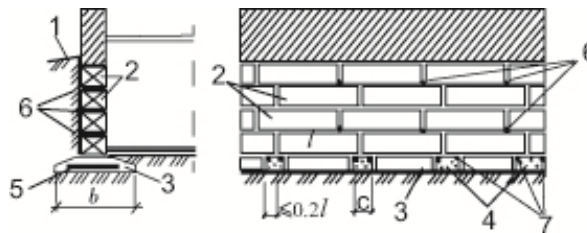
Армирование фундамента по периметру сооружения
